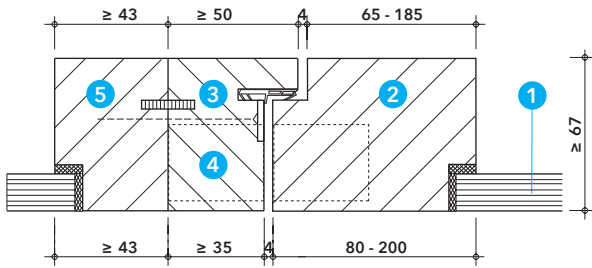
Detail A - Wandanschluss Leicht- bzw. Massivbauteil
